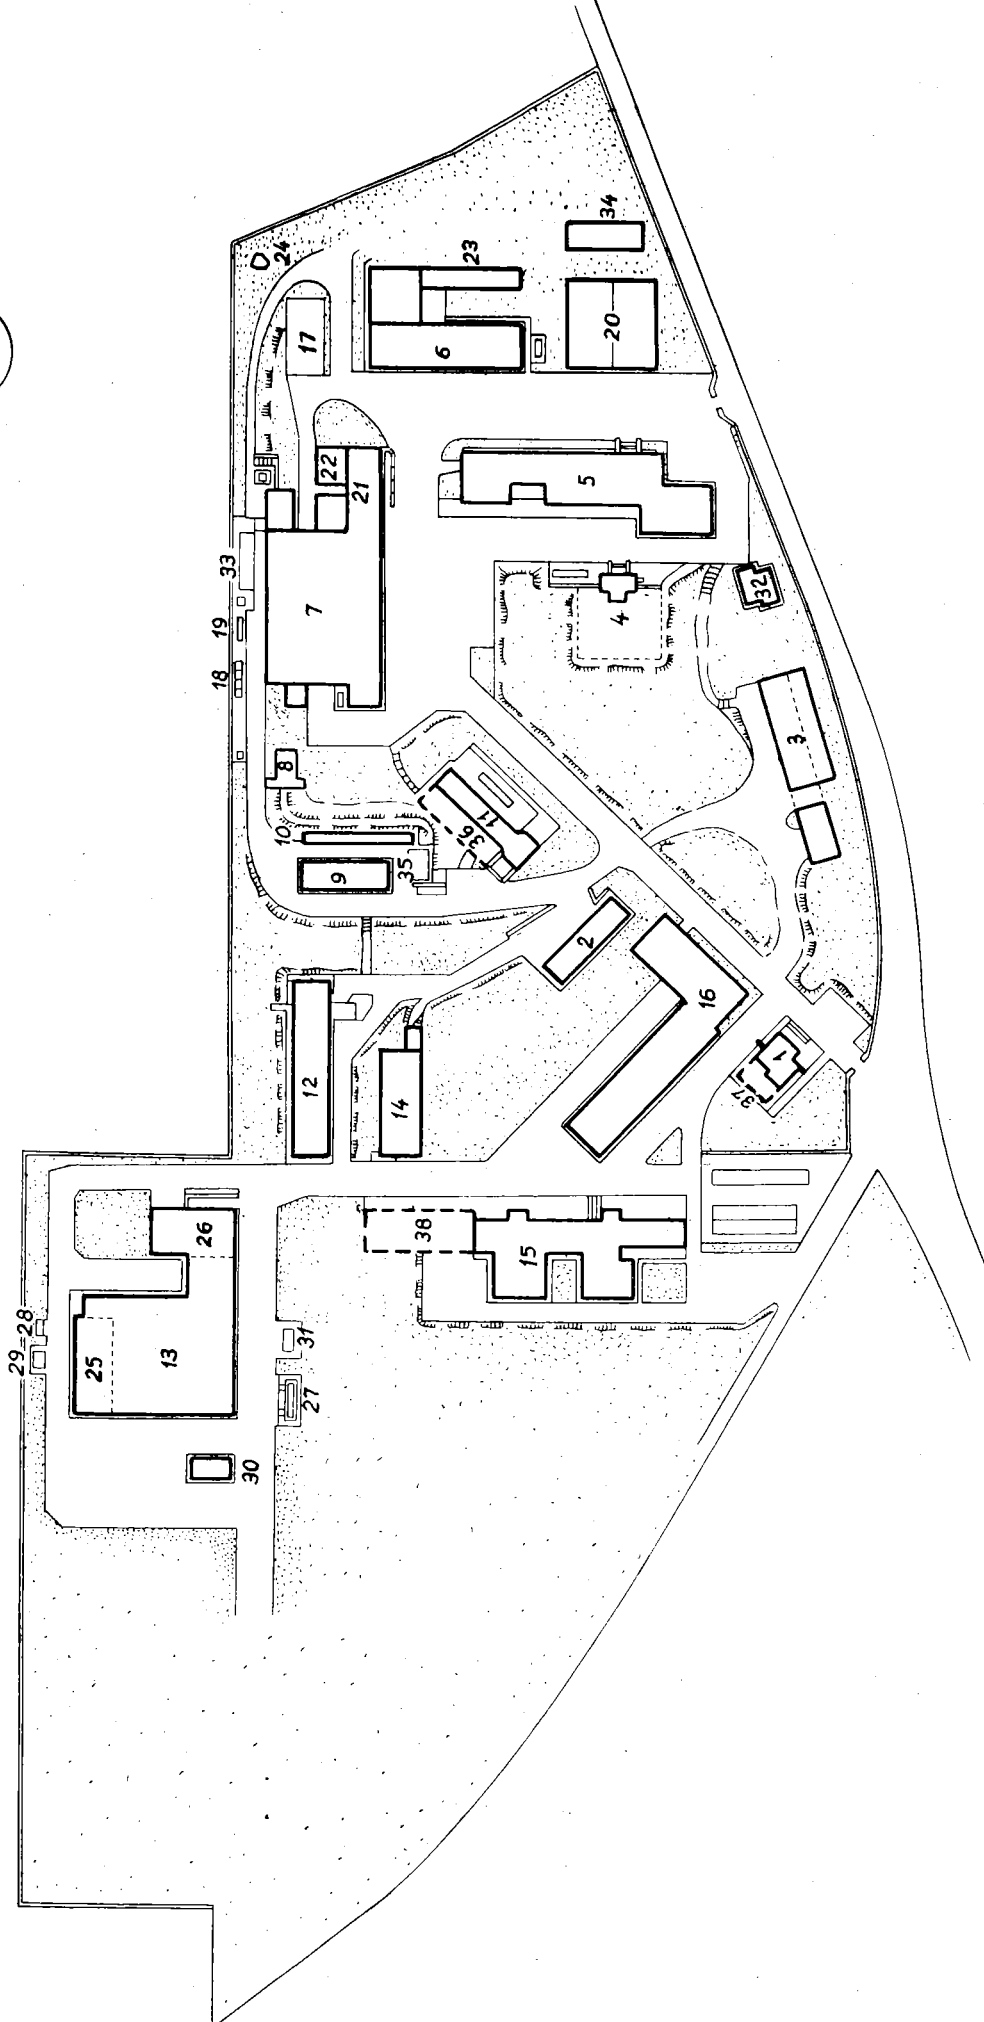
PLANIMETRIA GENERALE - LABORATORIES GENERAL LAYOUT OF
